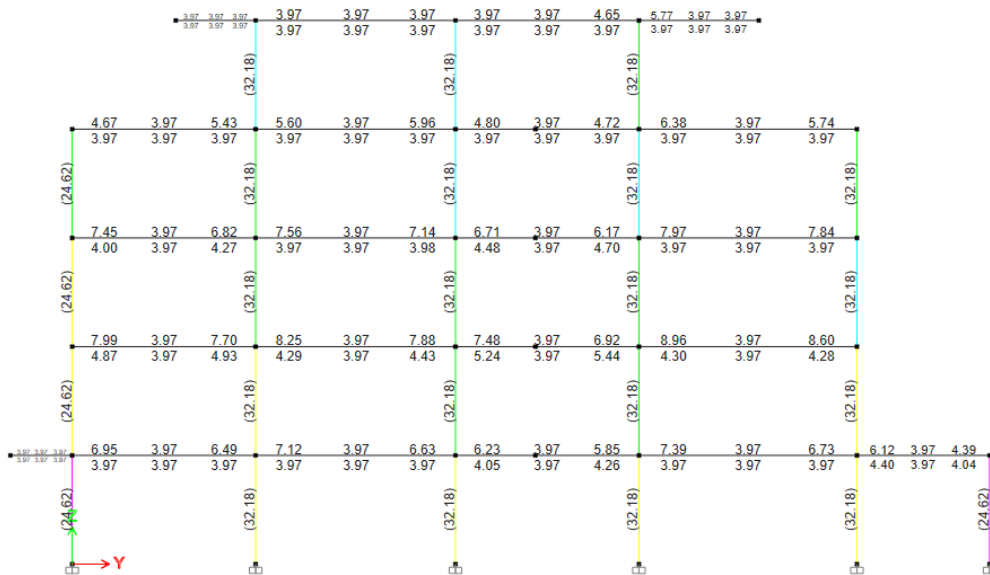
Aceros de Refuerzo Columnas (Etabs)
